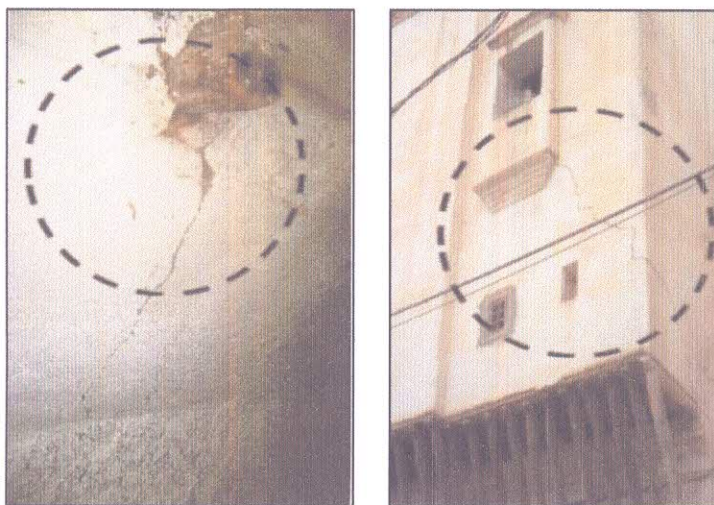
L'apparition des fissures dans les murs en pierre au niveau des planchers
